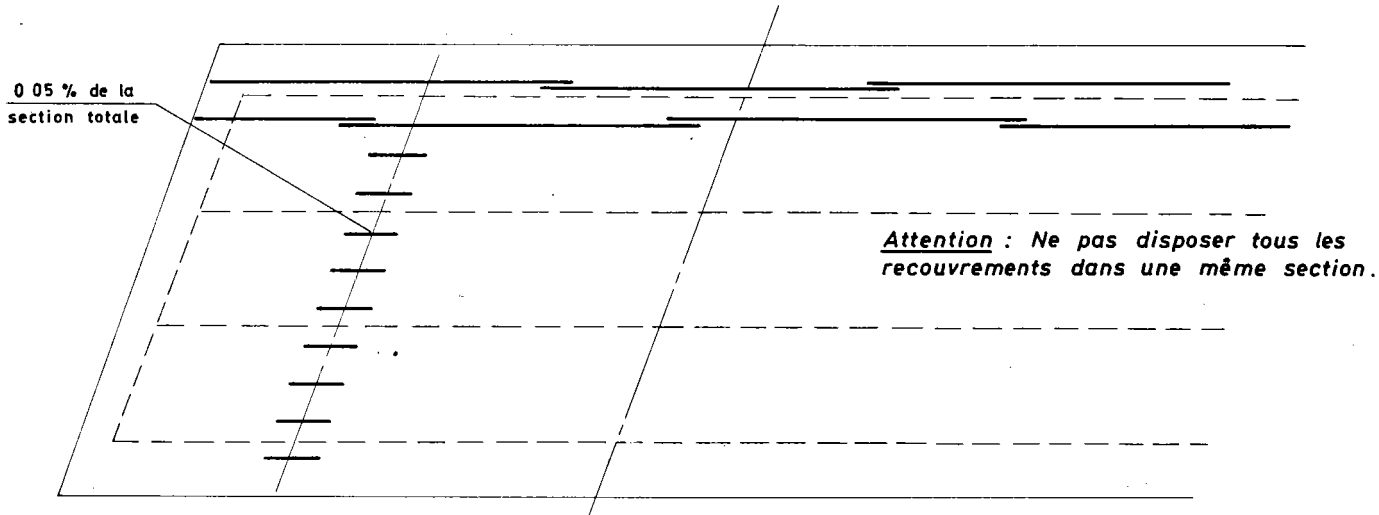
Schéma de ferrailage en fibre supérieure d'une dalle
